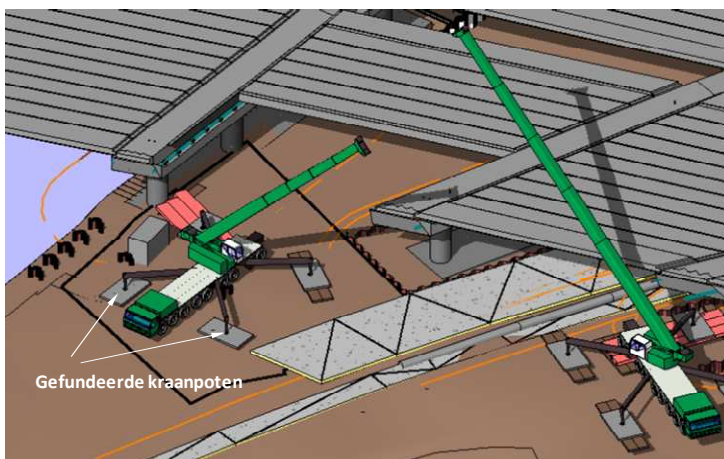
Opstelling kranen Westzijde - in de schaduw van de betonnen poeren
